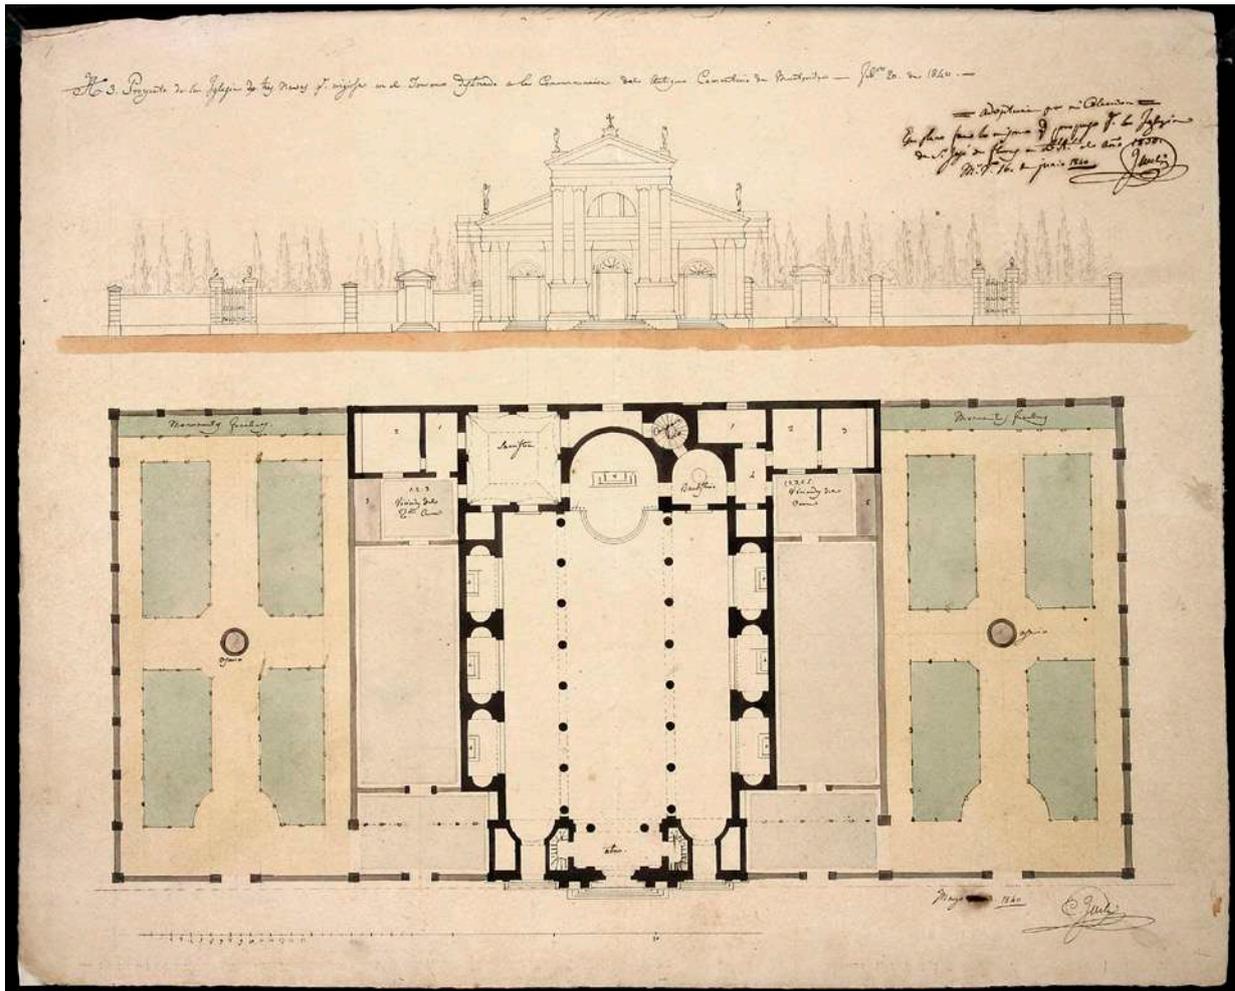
Zucchi, C. Planta y alzado del tercer proyecto de intervención para el Cementerio Viejo. 16 de Junio de 1840. Foto cedida por el investigador Fernando Aliata
